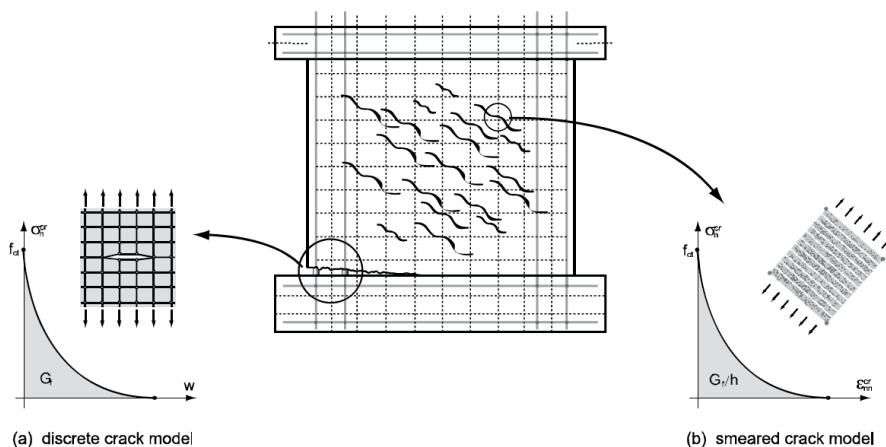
Modelos de fisuración de hormigón [62]
